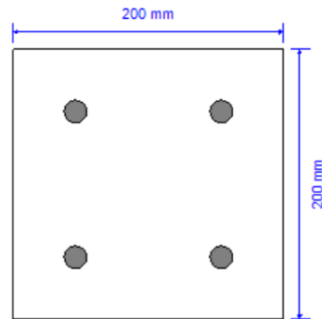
Viga de 20 x 20 cm planteada en la estructura. Fuente: Propia.
